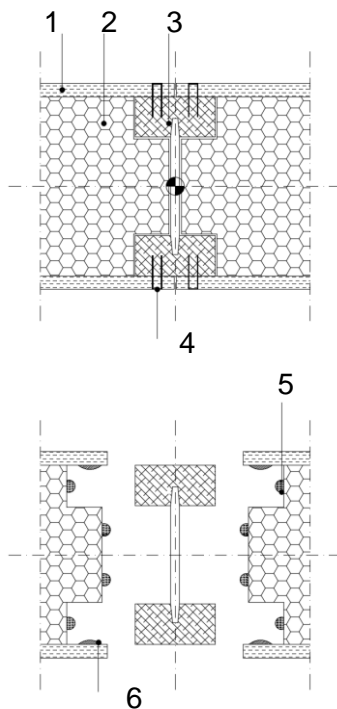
Spoj panelů – vložený hraněný profil (80x140) [2]
